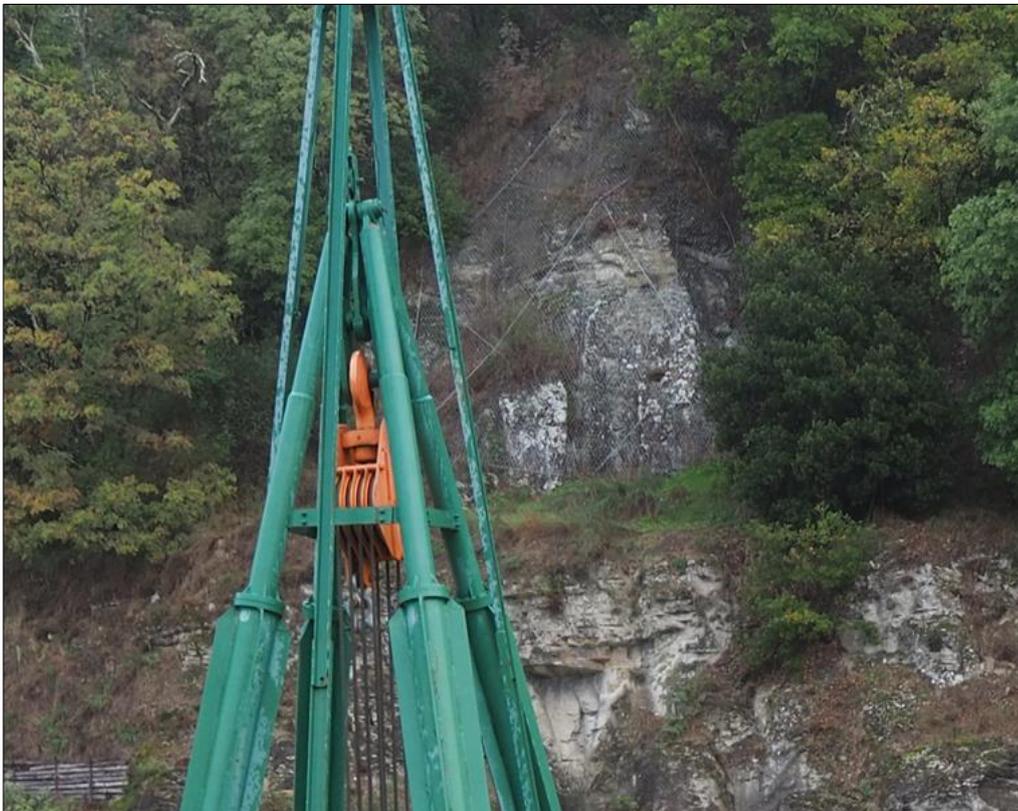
sponda destra, vista interventi di sistemazione con reti e funi metalliche
